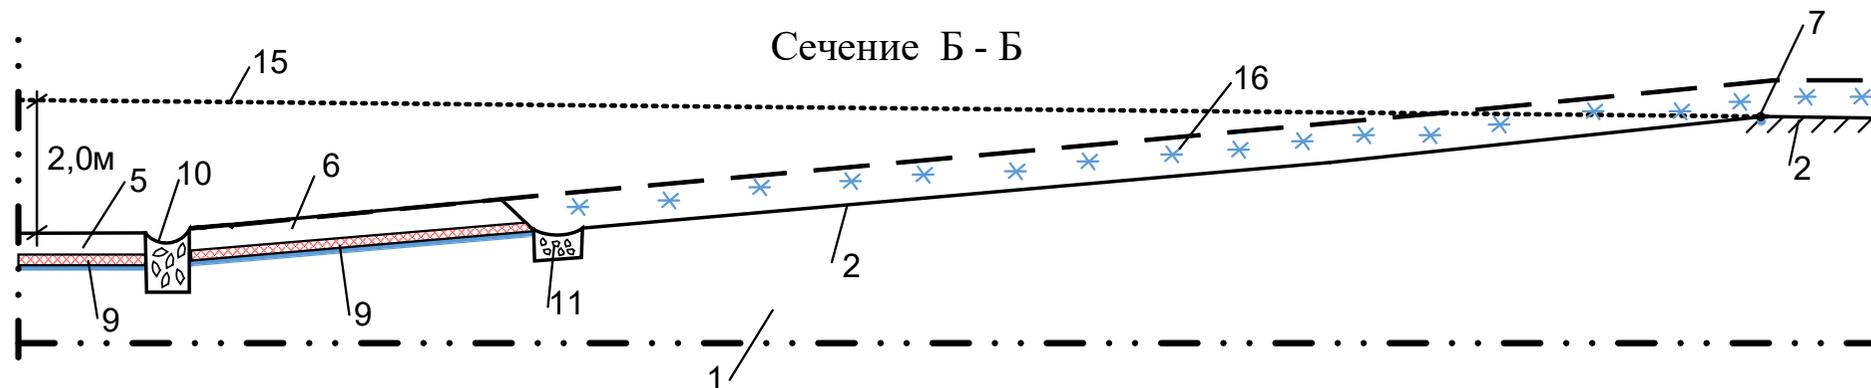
Принципиальная схема выемки глубиной 2,0 м в регионах с сильным снегопереносом (сечение Б-Б на рис. 6.5): 1 – грунты основания, 2 – естественная поверхность грунта, 5 – зона проезда, 6 – охлаждающая площадка, 7 – граница выемки, 9 – теплоизоляция, 10 - нижний кювет, 11 - верхний кювет, 15 - первоначальный уровень грунта, 16 – снежные отложения
